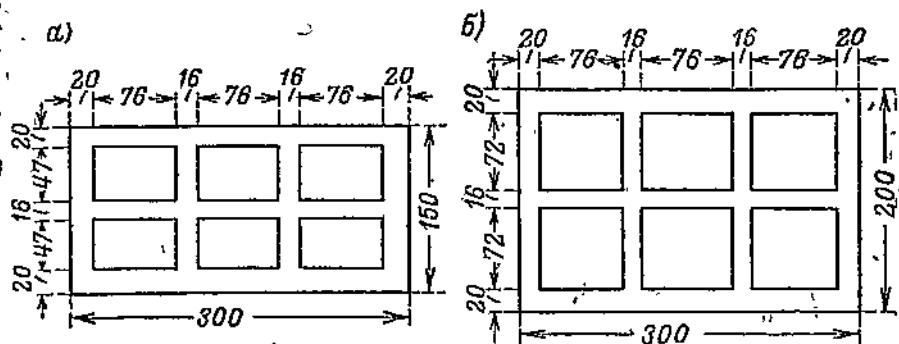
Блоки для перекрытий между взаимно пересекающимися железобетонными балками.
